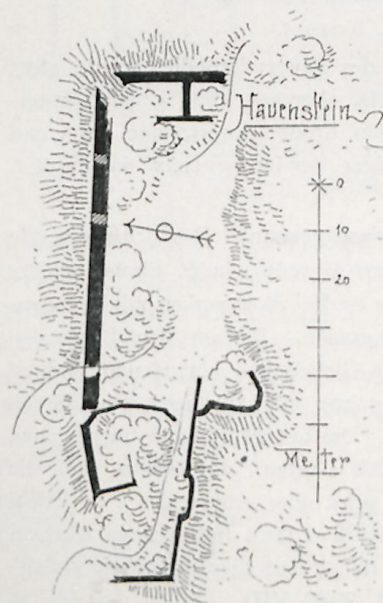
Hauenstein. Grundriss der Burg.
